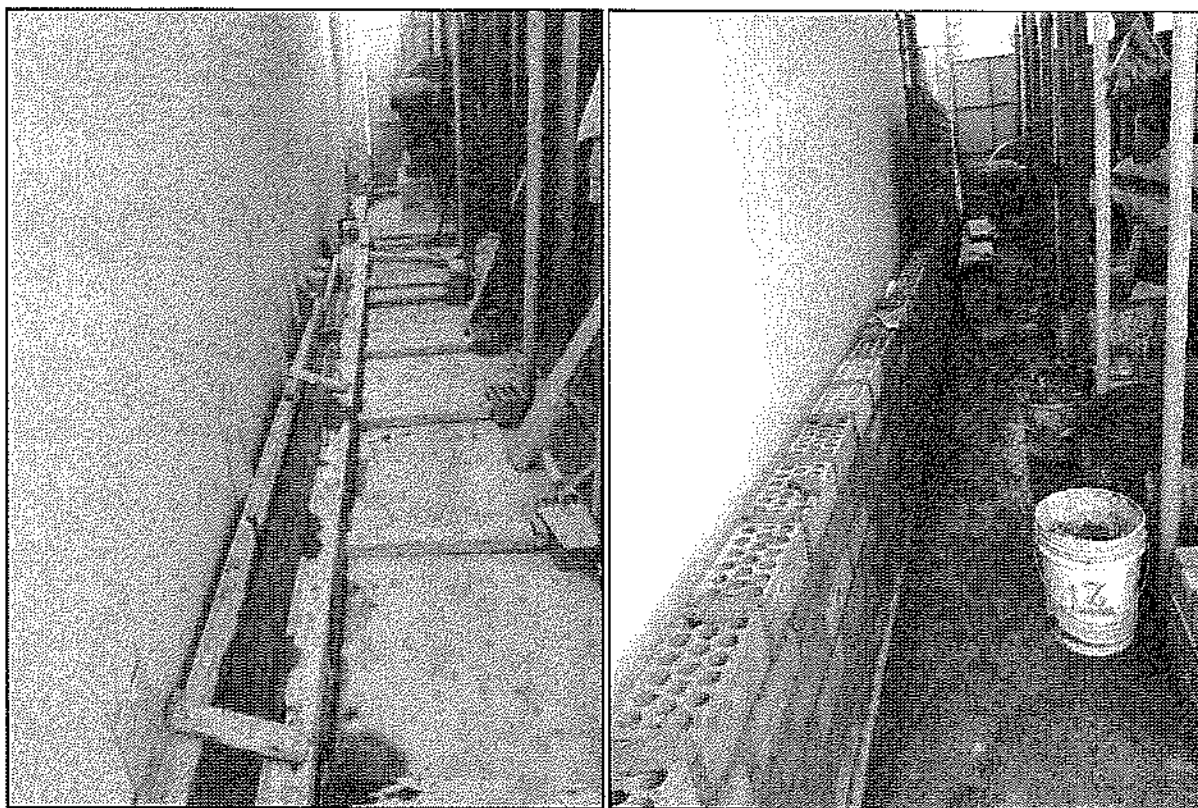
Armado, encofrado y vaciado del Sobre ciminetto -Lab Suelos y asentado de ladrillo
